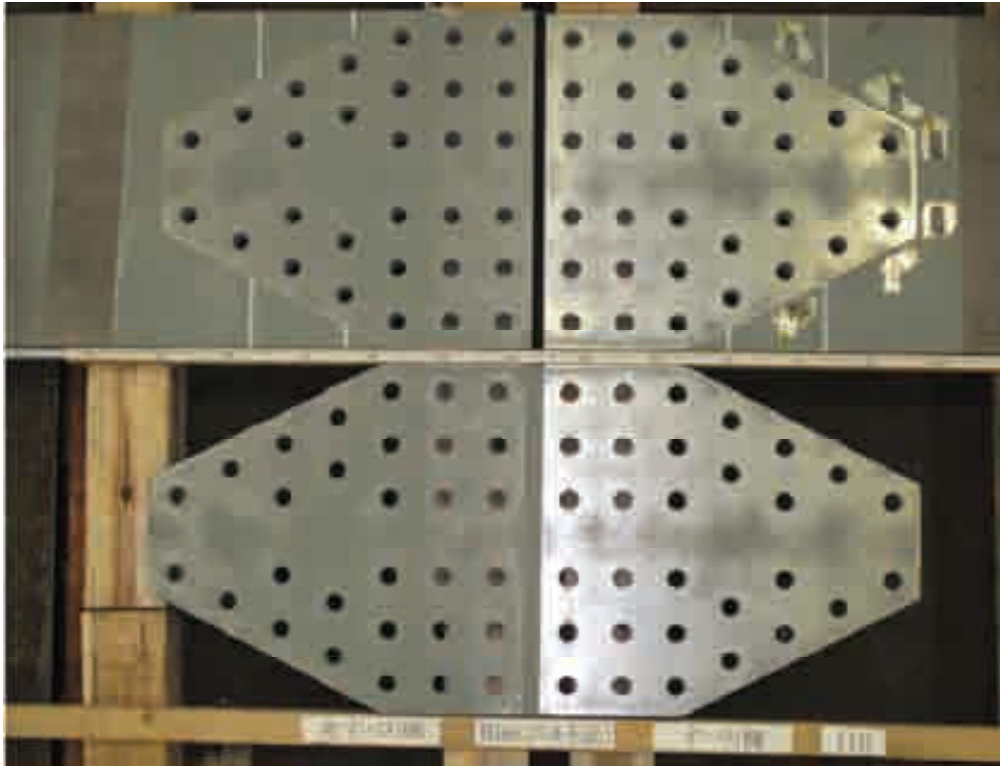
試験体 No.11-B すべり面の状況(ボルト側)
